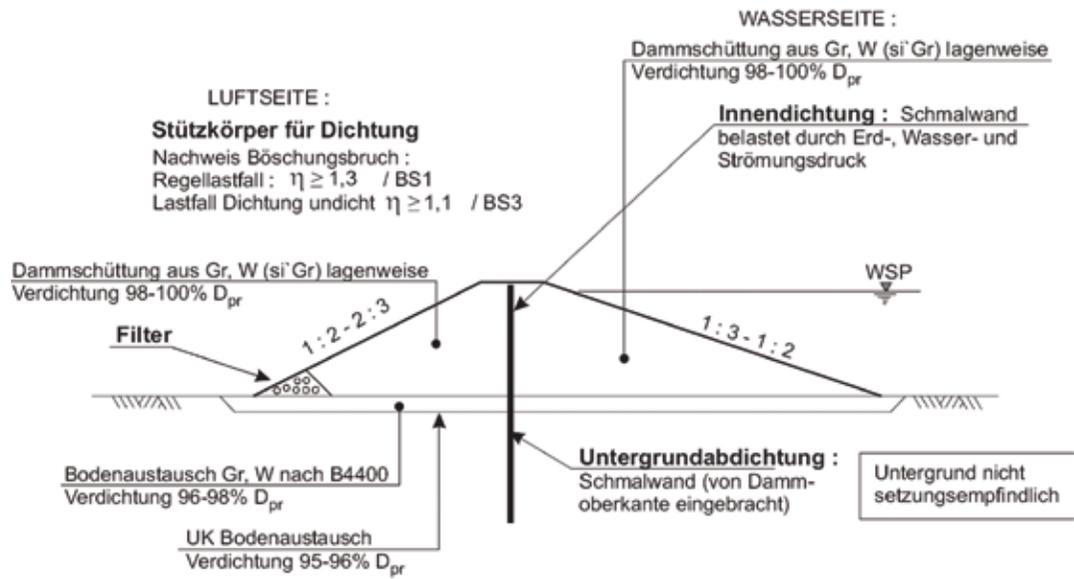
Bautyp – Damm und Untergrundabdichtung mit Schmalwand
